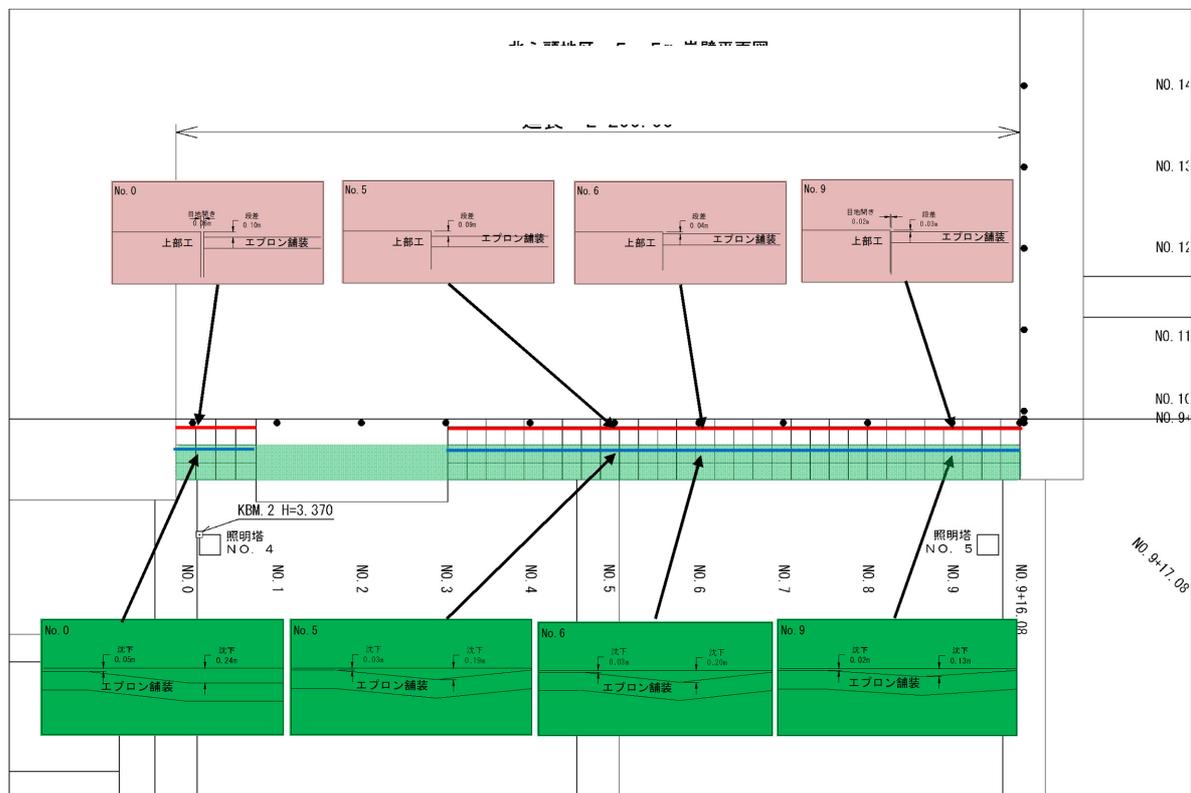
No.17 常陸那珂港区_北埠頭地区岸壁 (-5.5m) G、H の平面図 (被災後)
